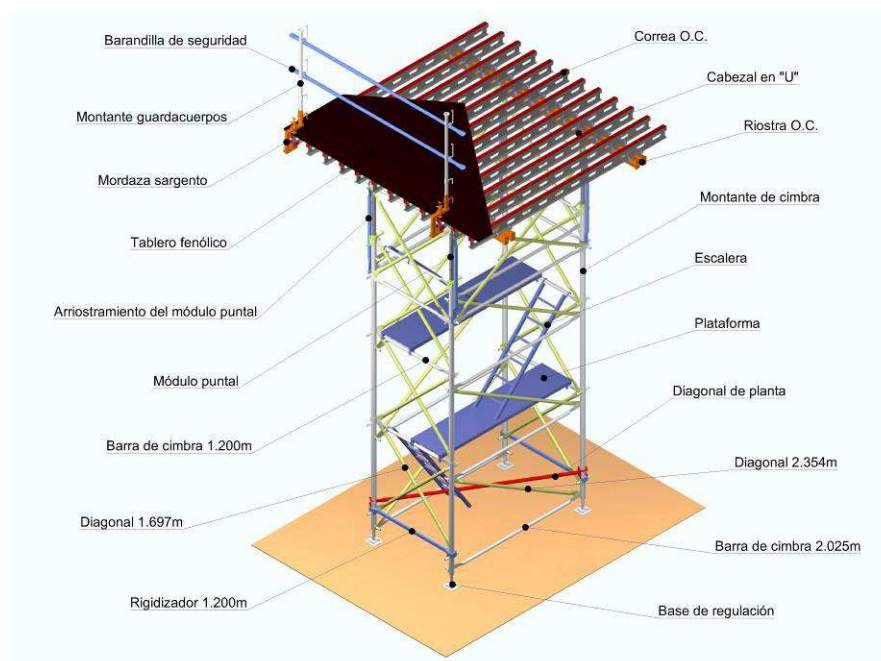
Elementos de una torre de cimbra y de la planchada horizontal
